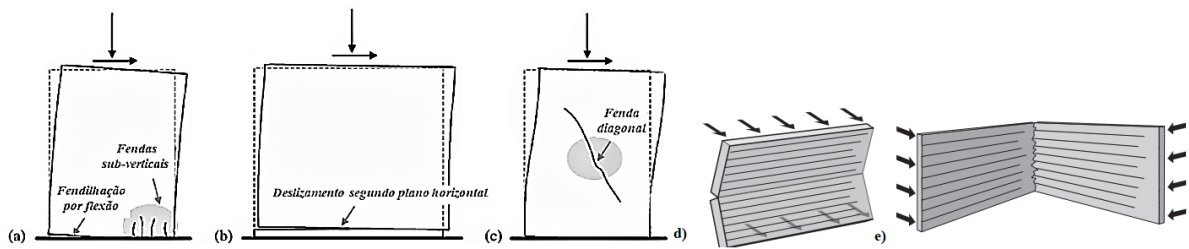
Tipos de rotura em paredes de alvenaria. Rotura no plano: a) derrubamento e esmagamento; b) deslizamento; c) fendilhação diagonal. Rotura fora do plano: d) derrubamento paralelo às juntas de assentamento; e) perpendicular às juntas de assentamento (Adaptado de Gago (2014) e Moore J. *et al.* (2008))
